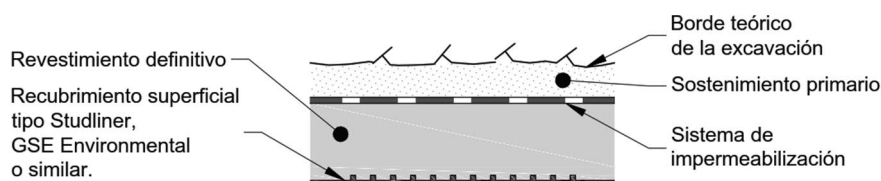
Detalle del sistema de impermeabilización del pozo
